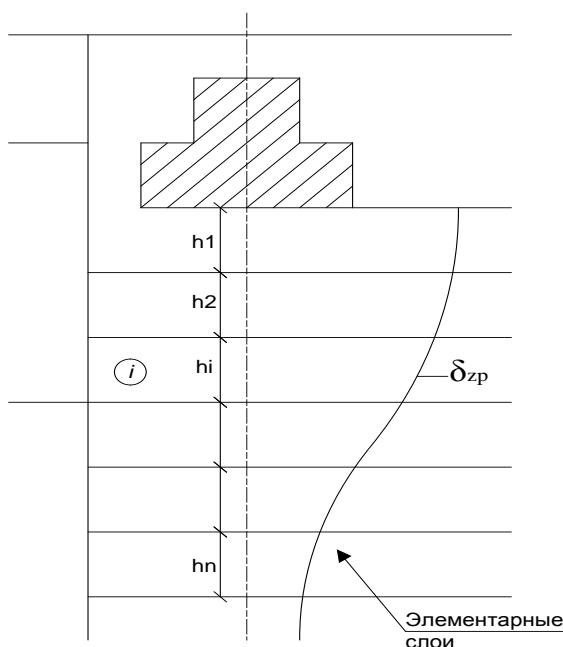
Расчетная схема к определению осадки фундамента методом послойного суммирования
